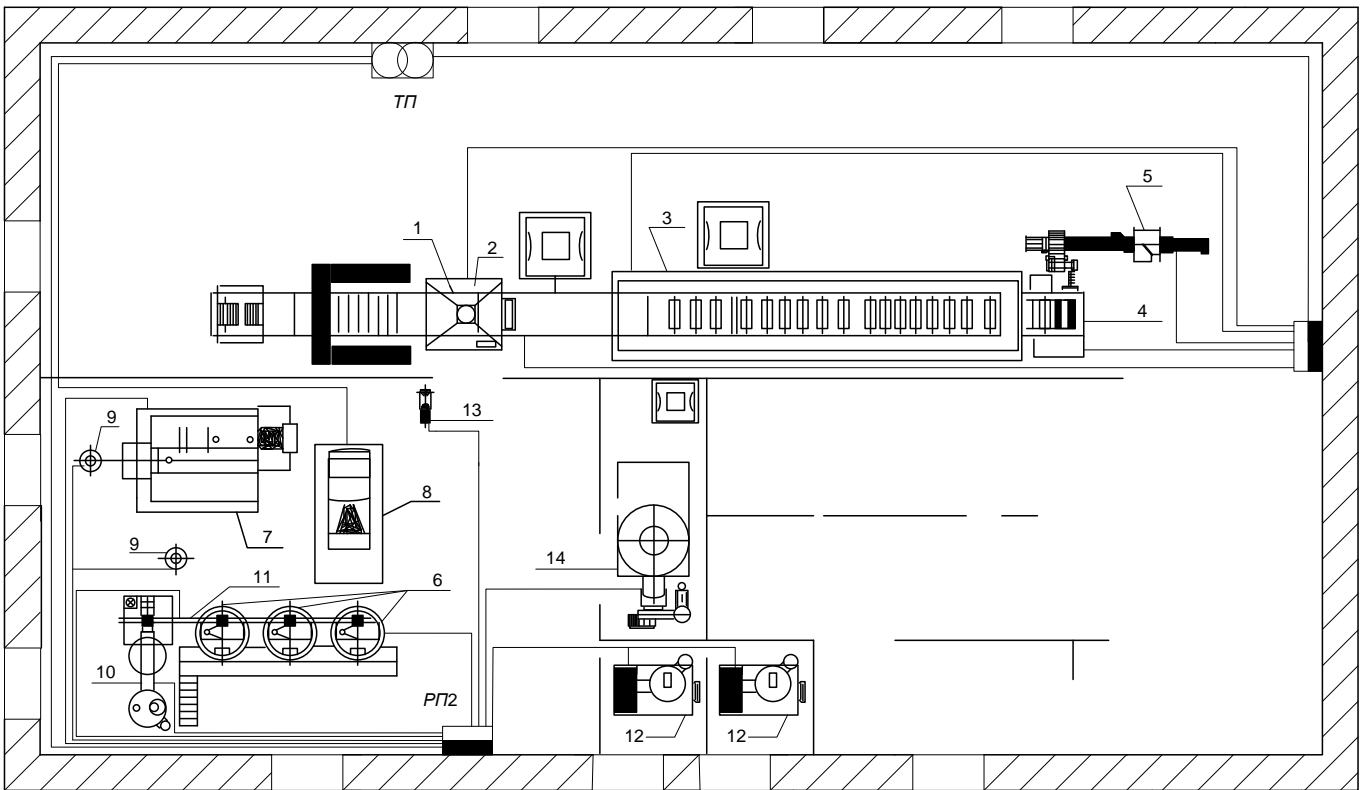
План руберойдового цеху з силовою мережею
